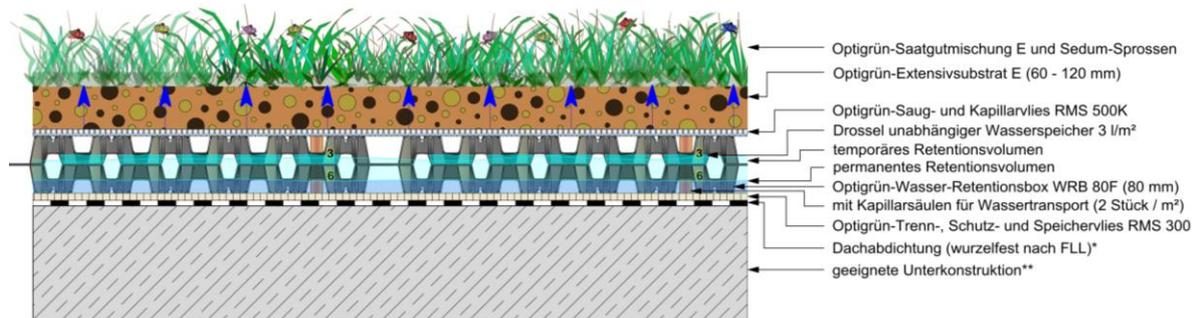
Dachbegrünungssystem als Retentionsdach mit Regenrückhalt und Abflussverzögerung. Beispiel eines Dachaufbaus der Firma OPTIGRÜN;
